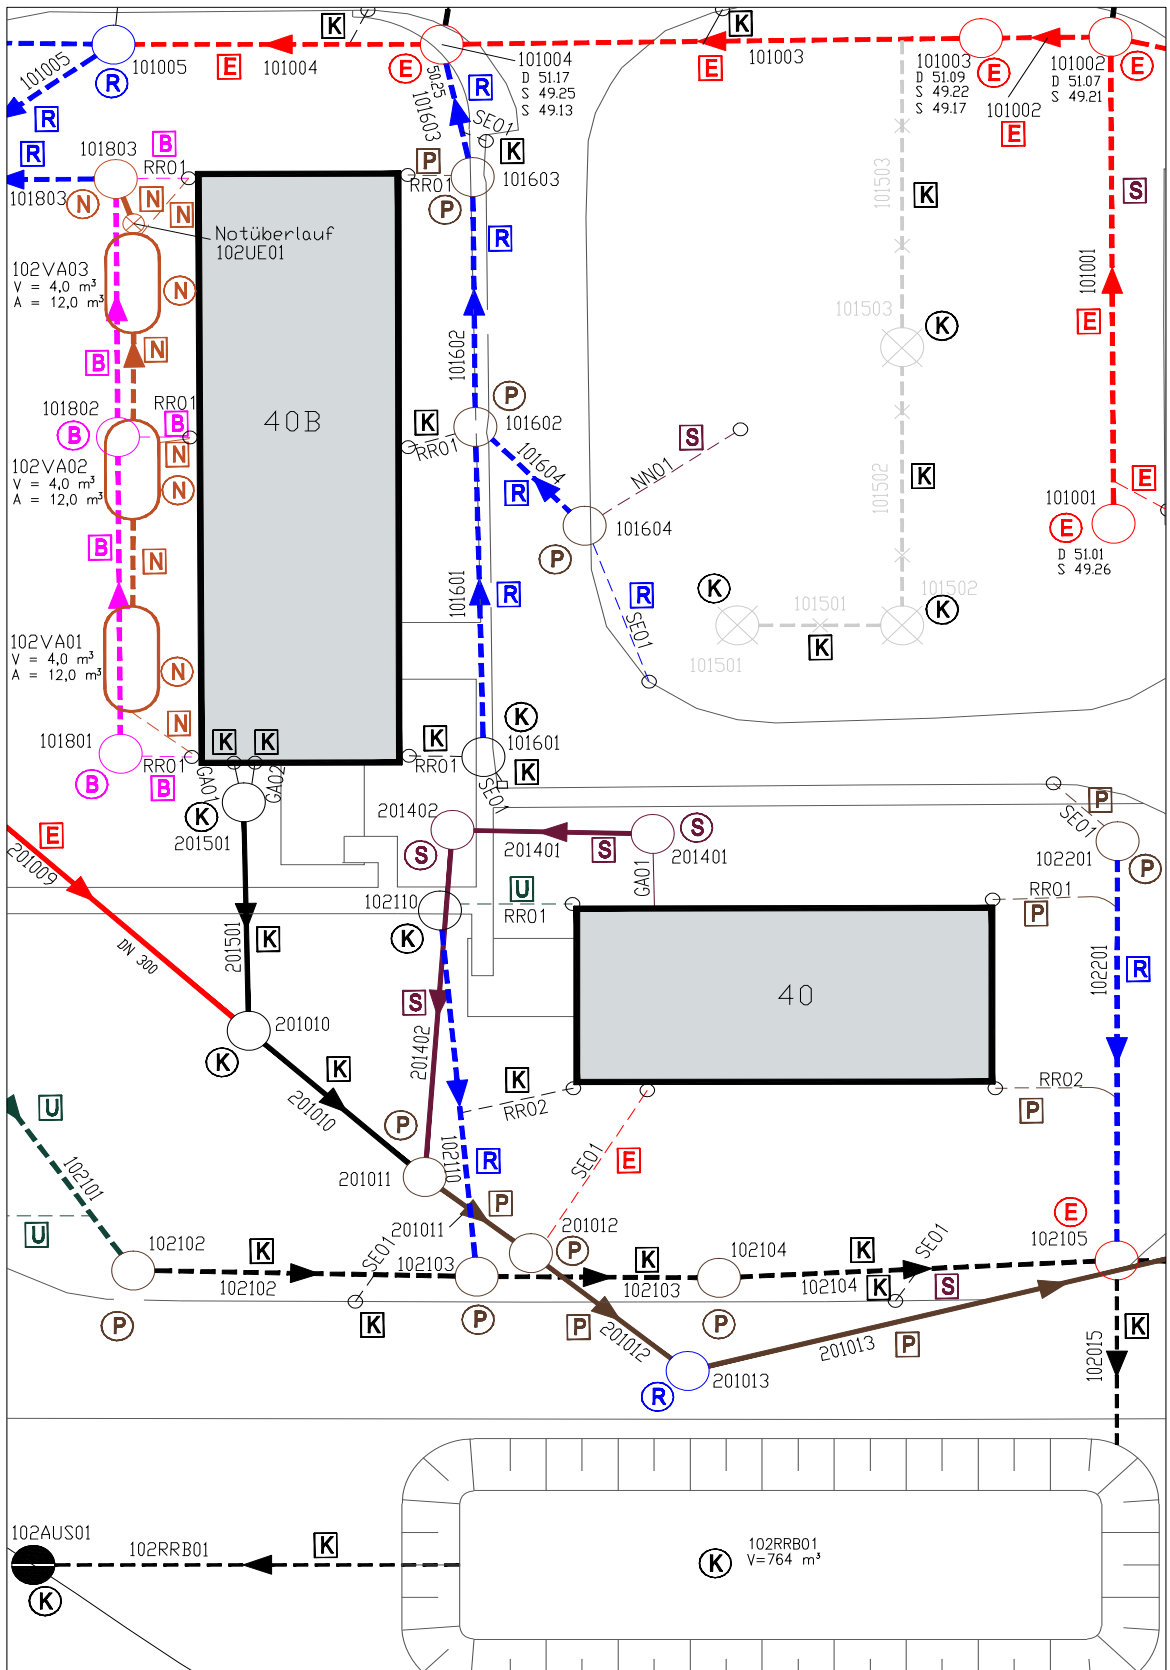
12 Beispielplan: Lageplan „Sanierungskonzept“
